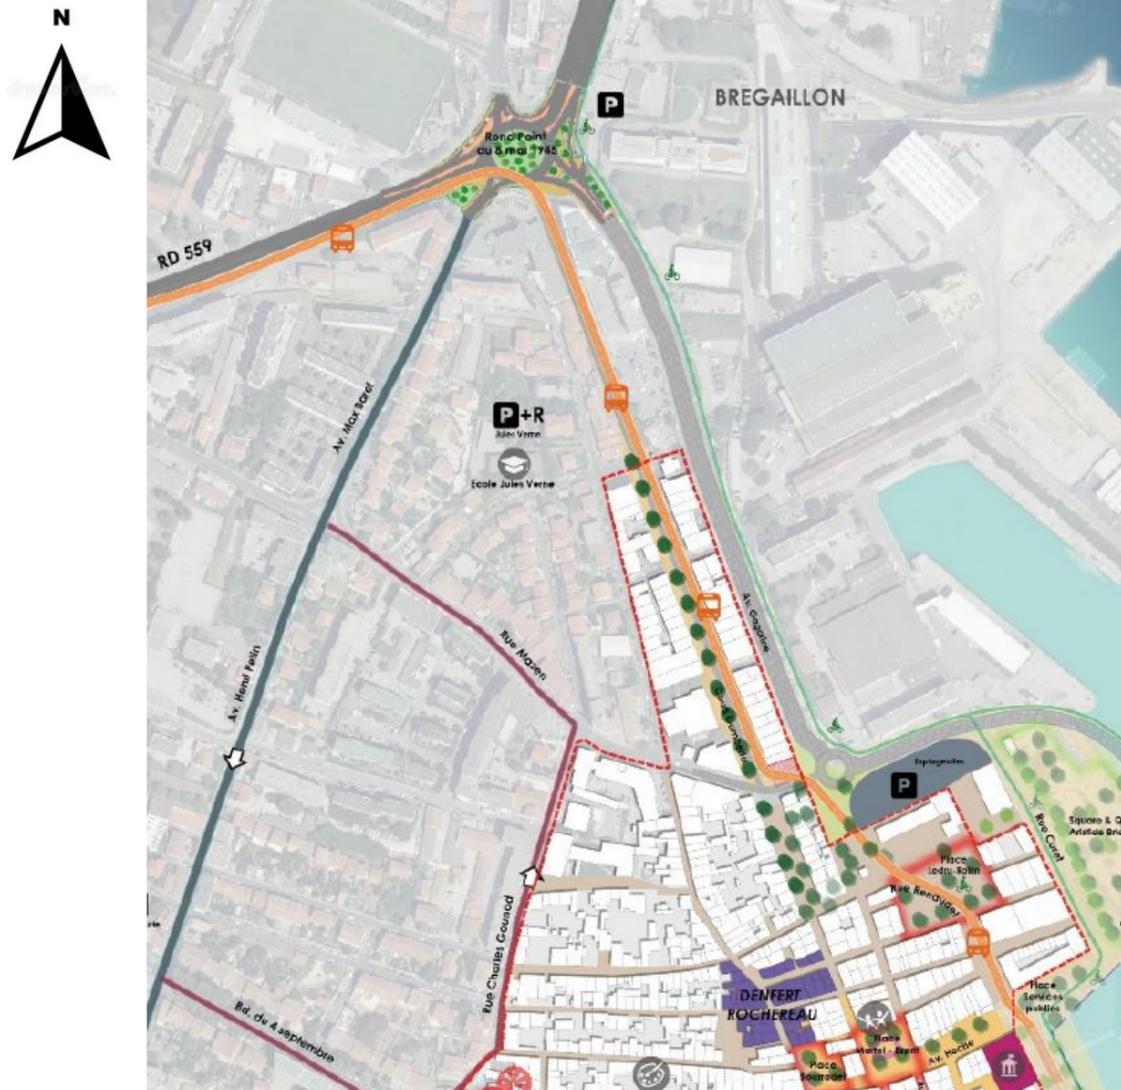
AMENAGEMENT AVENUE GAMBETTA – EXTRAIT PLAN GUIDE NPNRU
